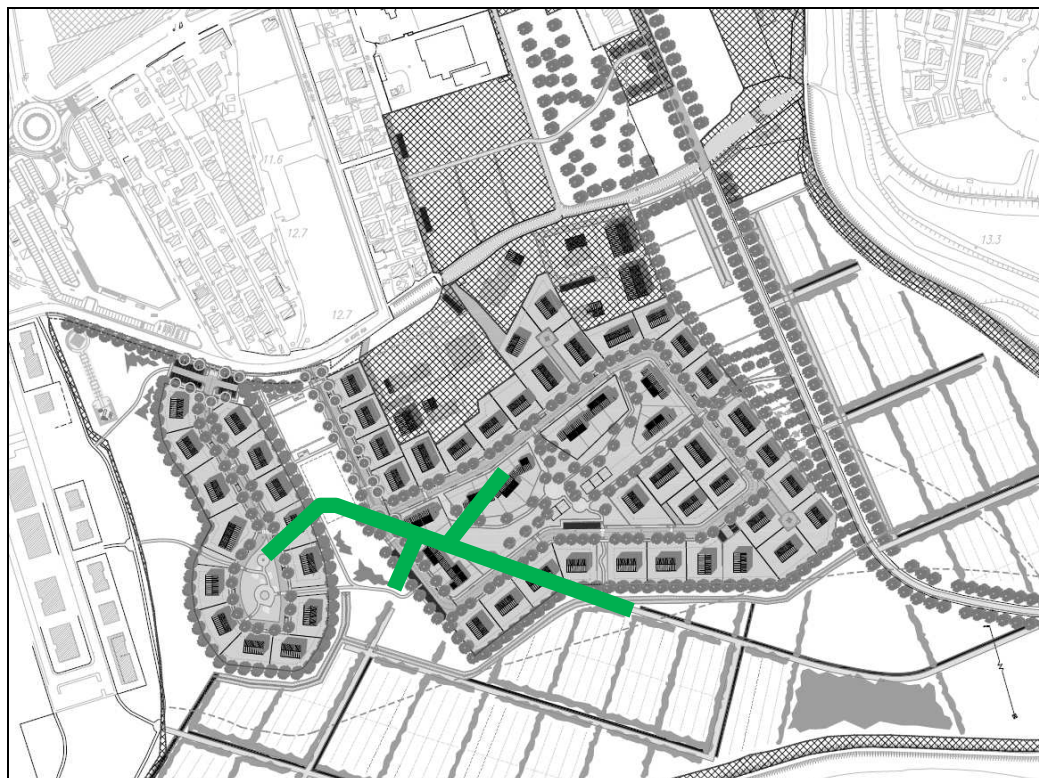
Planimetria del Piano di Lottizzazione Brentella con indicazione (in verde) delle scoline da tombare.
